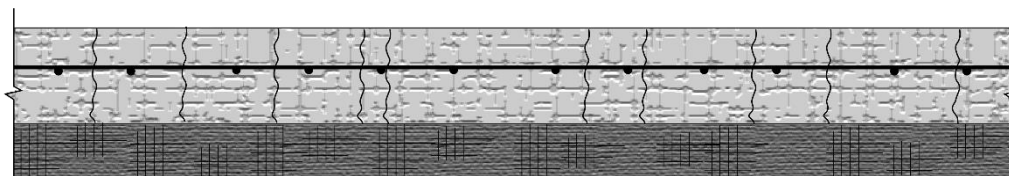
Perfil de pavimento rígido de betão armado contínuo (B.A.C.) (adaptado de OLIVEIRA, 2000)
